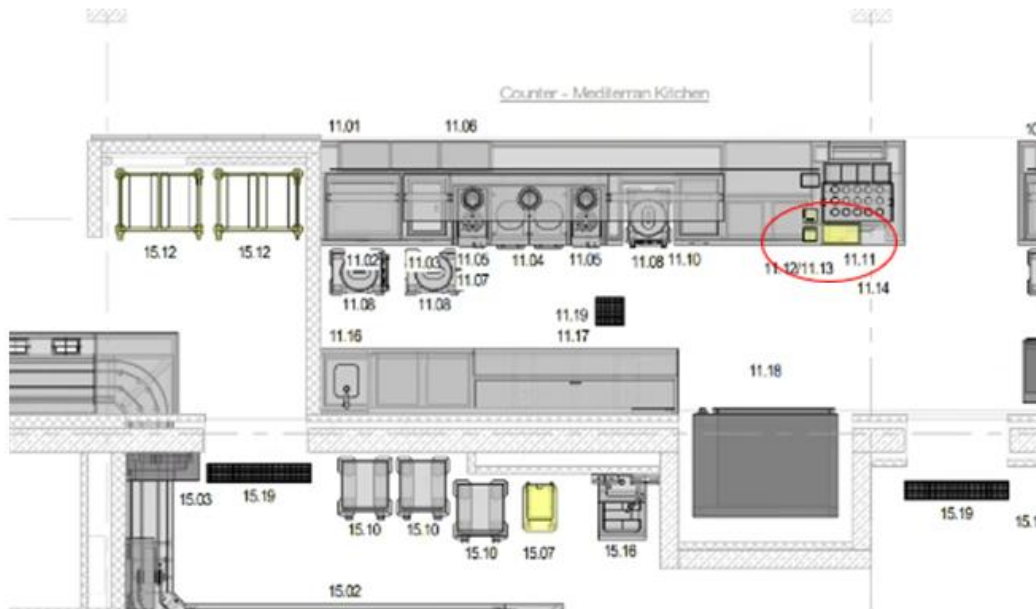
Grundriss-Auszug Counter Mediterran Kitchen – Position der Kassenstation 1
